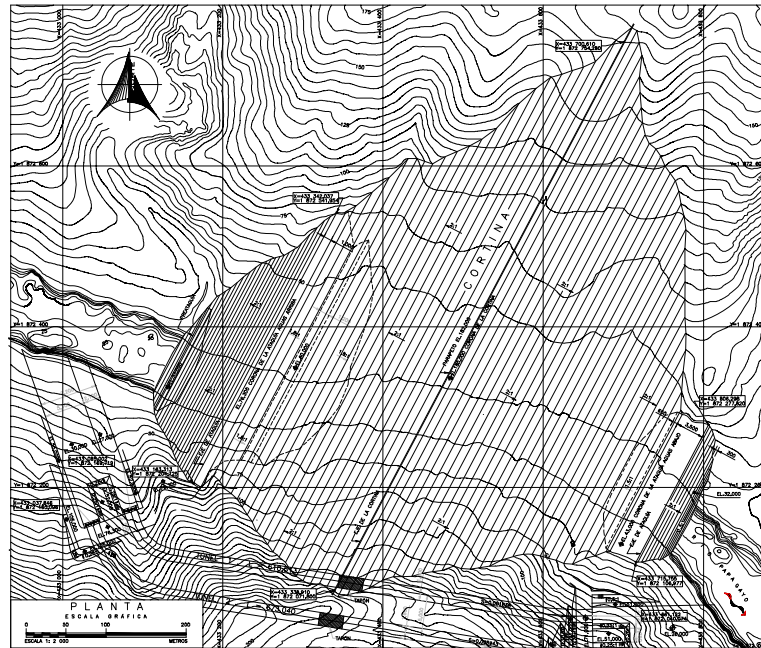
Planta topográfica donde se sitúa la cortina
